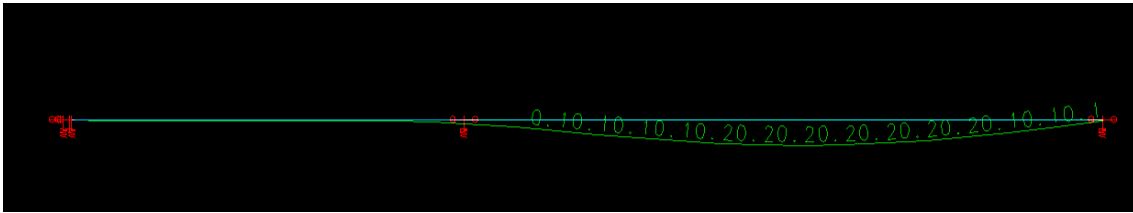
Deslocamentos verticais Viga V18 do 1º pavimento, concreto armado (CAD/TQS).
